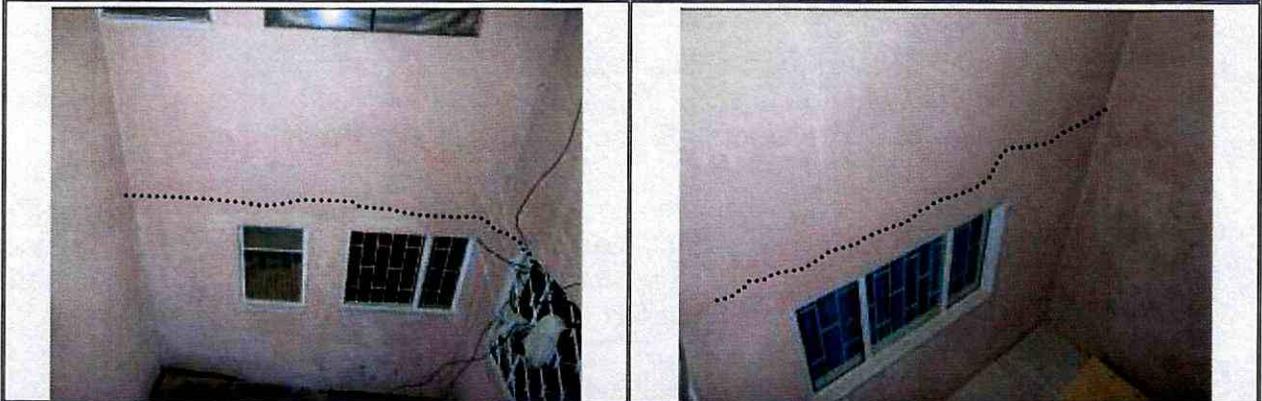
y 4. Fisuras en muros de la parte interior de la vivienda
